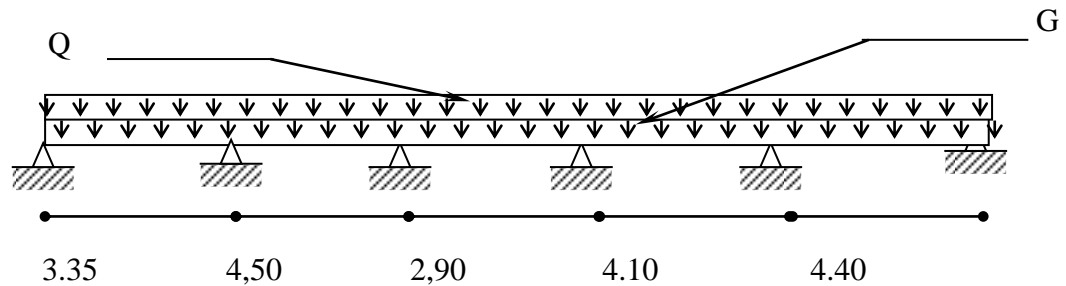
schéma statique de la poutrelle à plusieurs travées.
